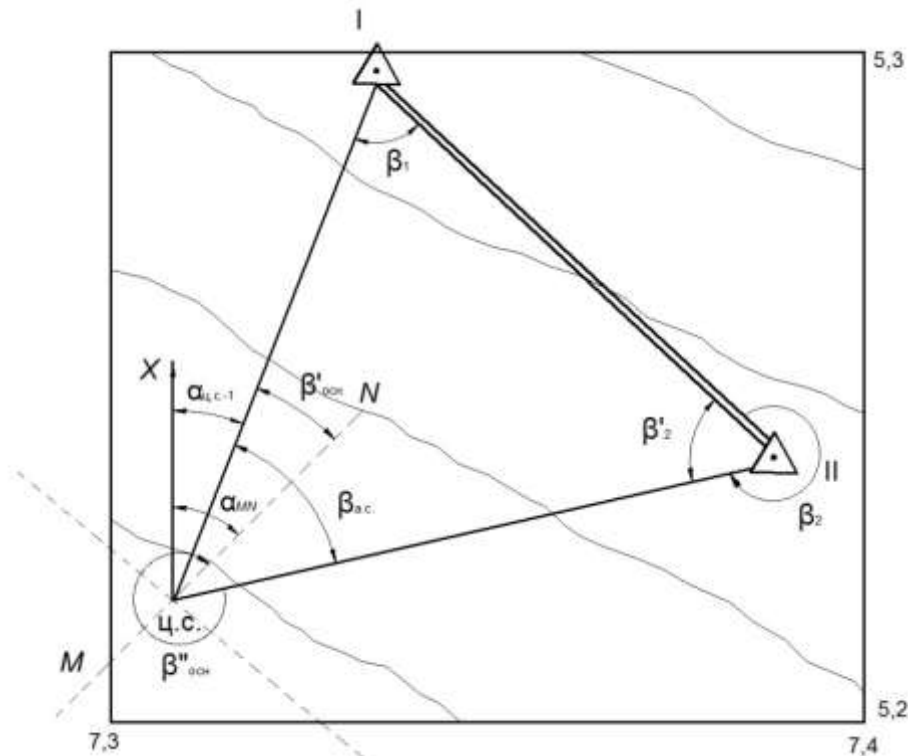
План разбивки центра вентиляционного ствола и строительных осей
